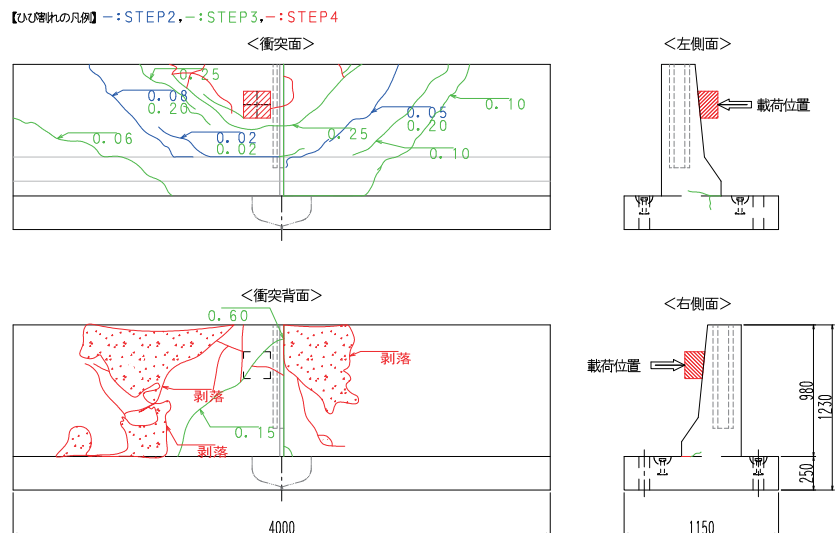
ひび割れ図(試験体③, 荷重 STEP4)
